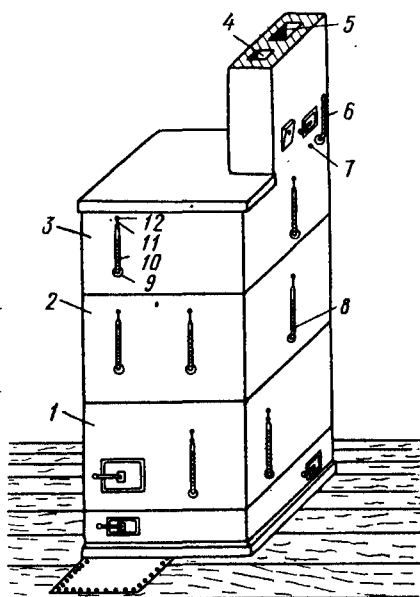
Печь, оборудованная измерительными приборами для испытания:
